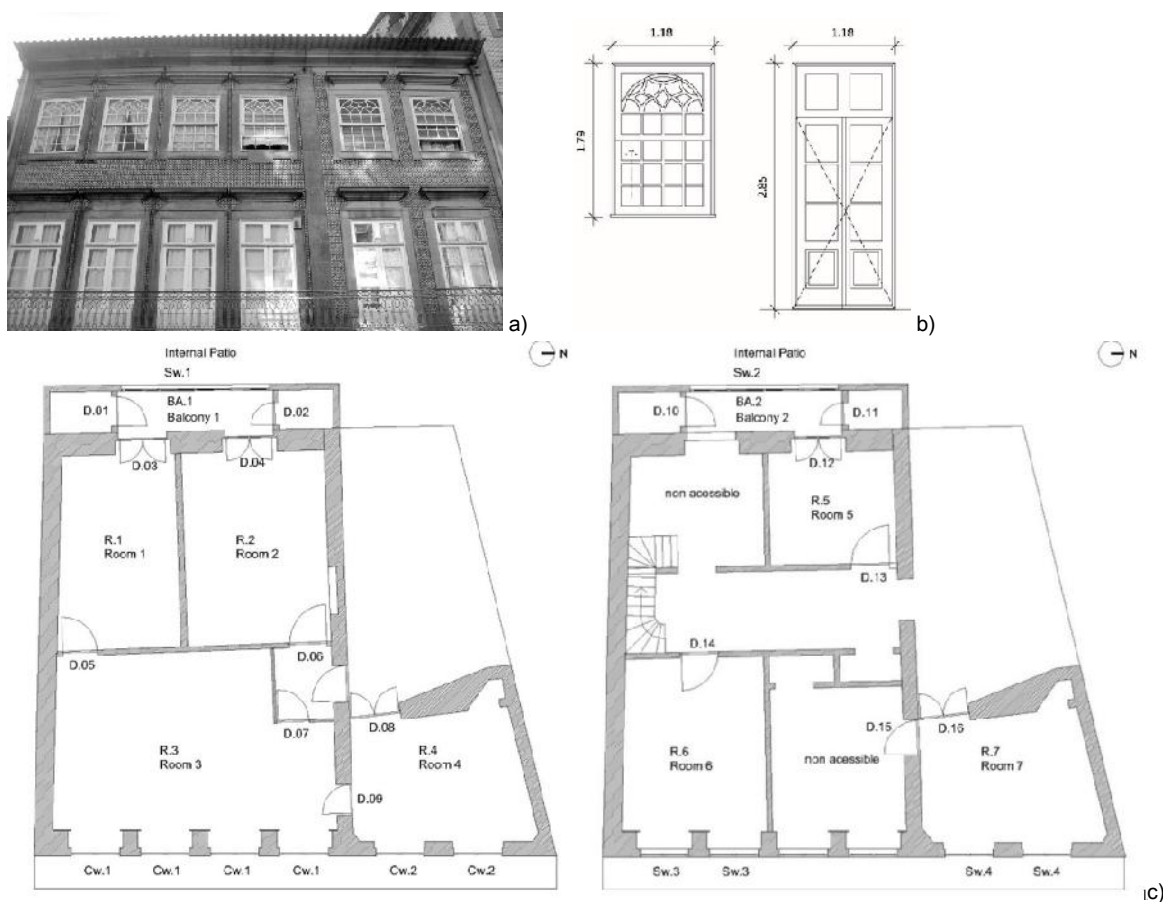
a) Fachada principal del modelo: Primer piso – Ventanas de balcón: Cw.1 (R.3) y Cw.2 (R.4); Segundo piso: Ventanas de guillotina Sw.3 y Sw.4 (R.7); b) Detalle de las ventanas; c) Planta del primer piso (izquierda) y segundo piso (derecha).
